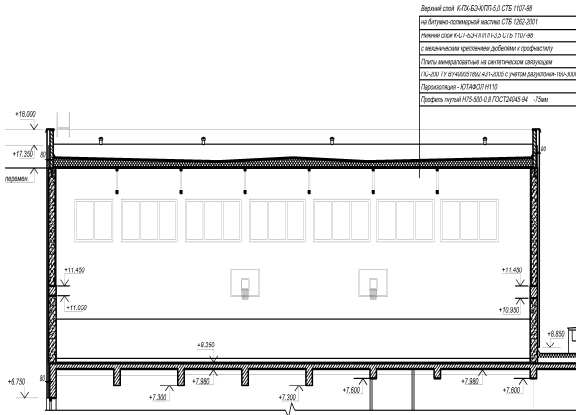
Несущие конструкции покрытия фермы из ГСП
